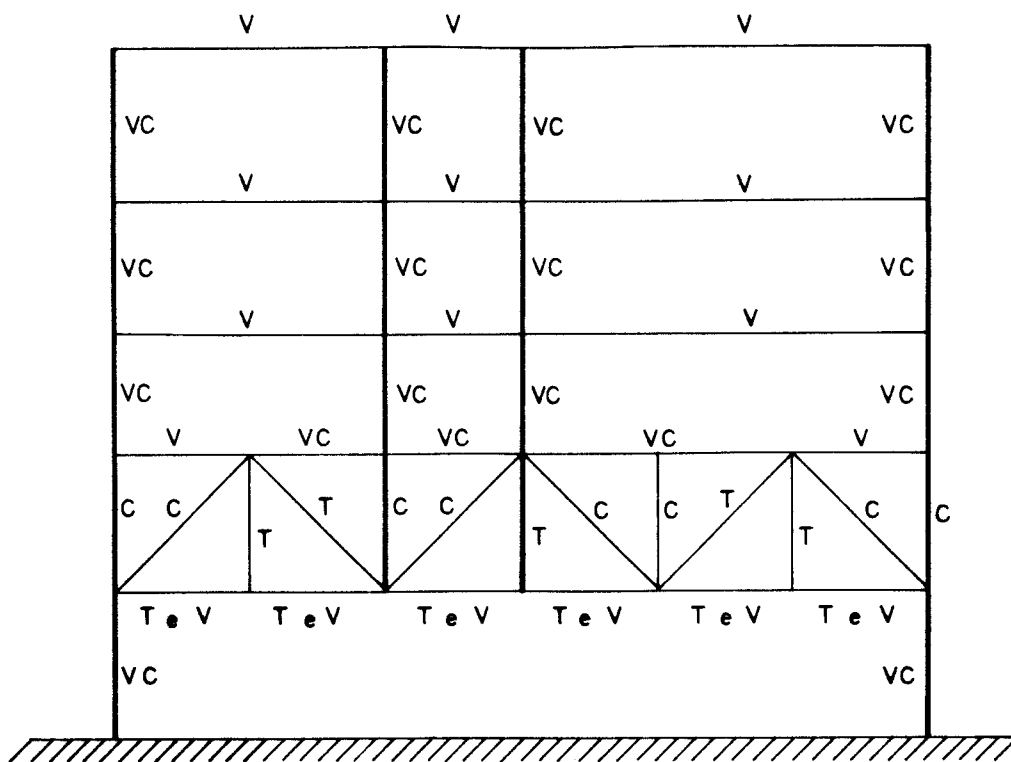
Quadros Estruturais Compostos de Vigas (V), Colunas (C), Barras Tracionadas (T) e Viga Colunas (VC)
